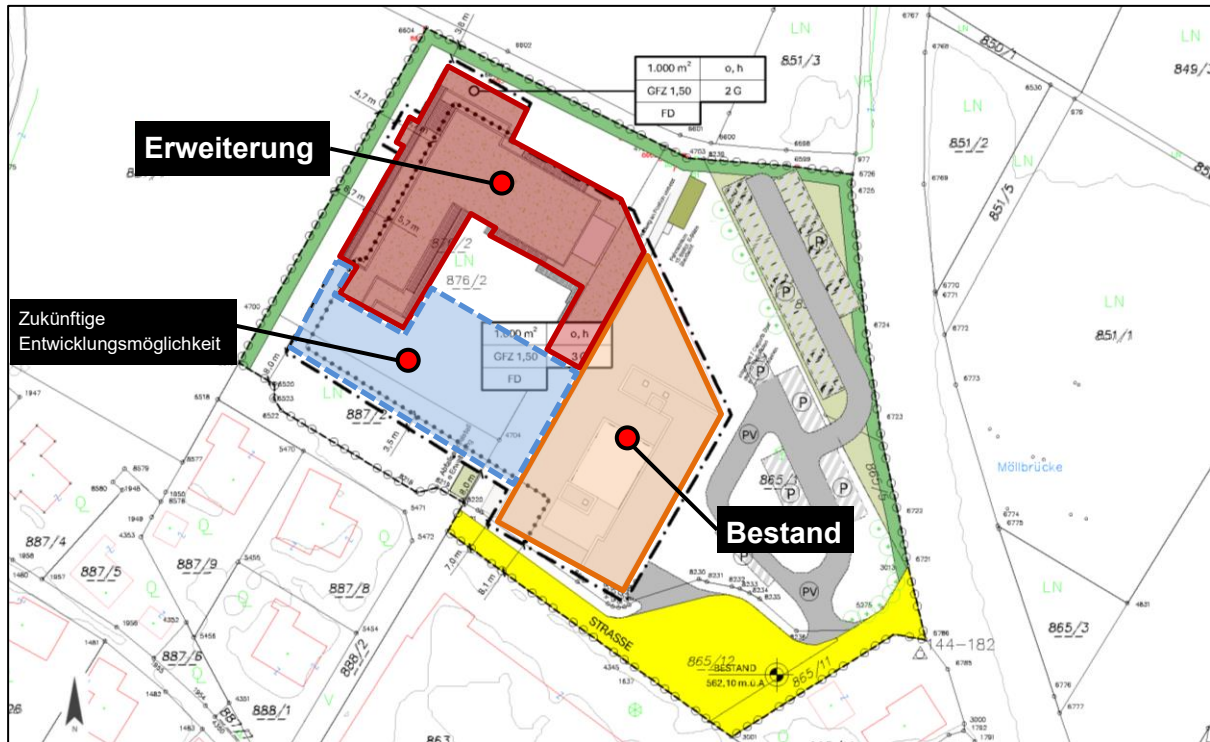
Lageplan mit Erweiterungsstufen (Quelle: Strabag SE, eigene Darstellung)
